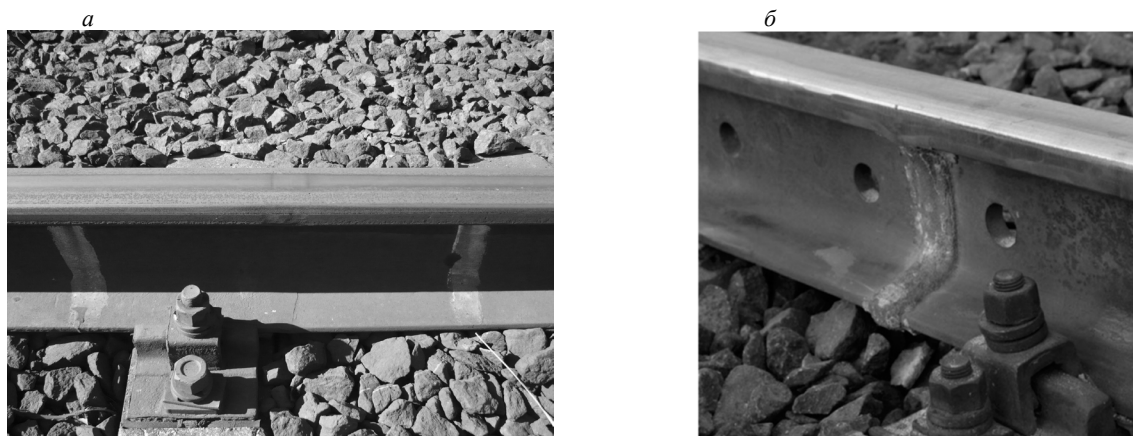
Сварные стыки рельсов, выполненные:
